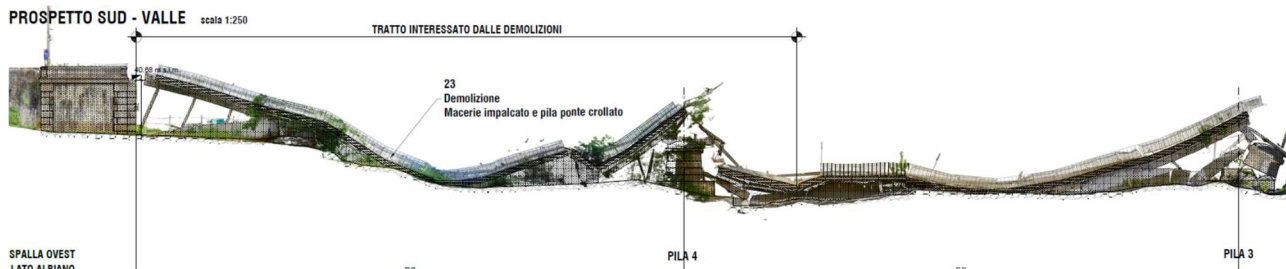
Prospetto con punto di presa da valle - Tratto di macerie da rimuovere già incluso nel progetto del nuovo ponte: campata 5 e pila 4 – estratto dall'elaborato 0902_T00DE00CANPL02A
